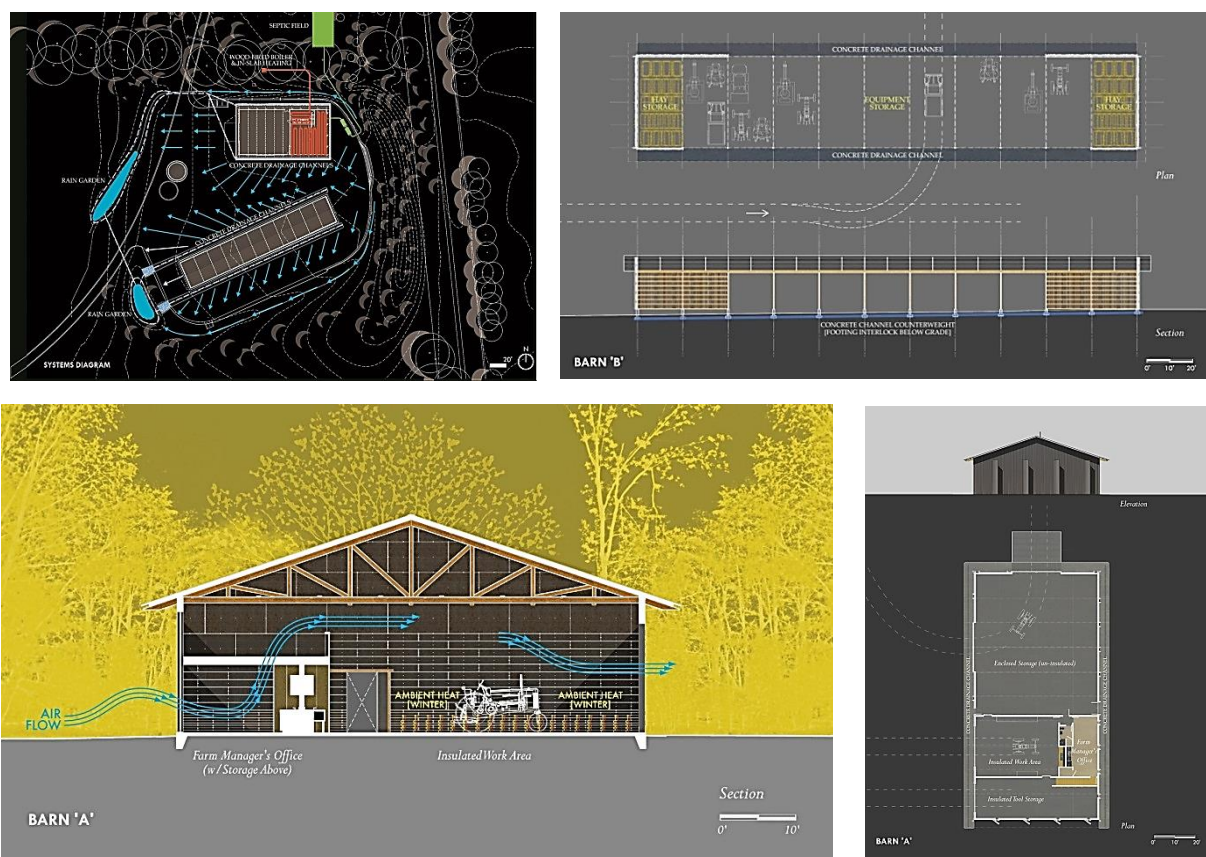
Генплан застройки и планировочные схемы зданий сельскохозяйственного комплекса «Mason Lane Farm Operations Facility», США, 2009
